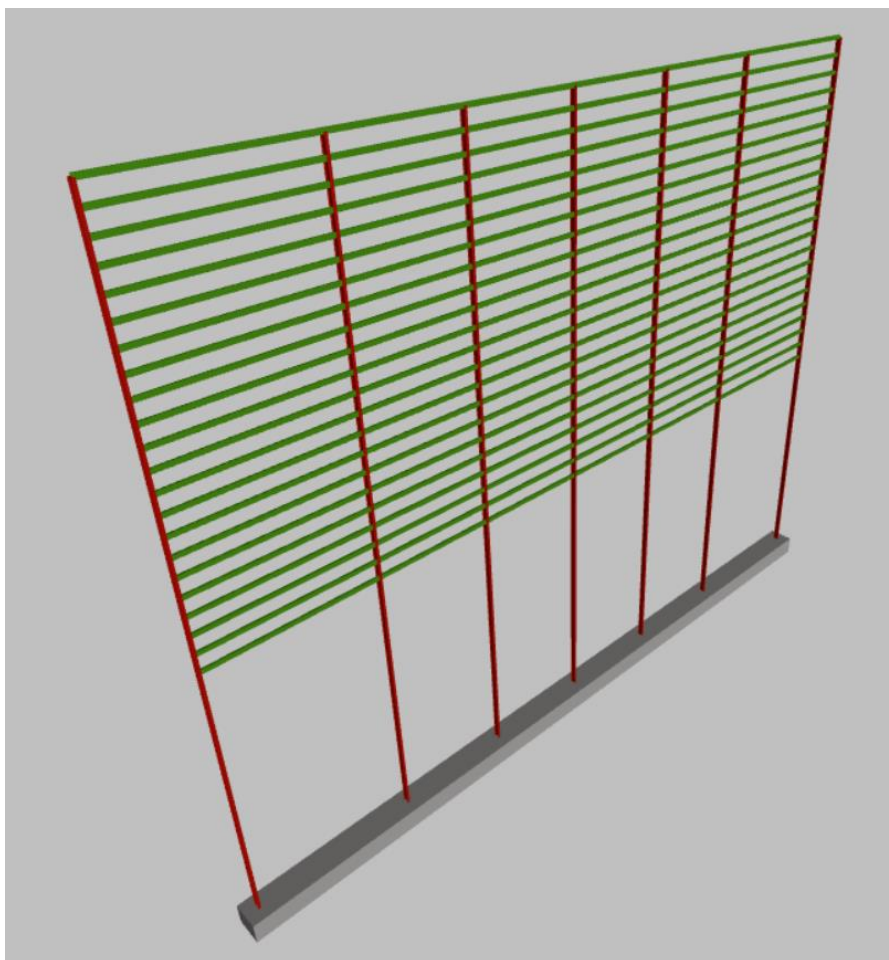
Estructura de soporte con cimentación (realizado en CYPE 3D)
